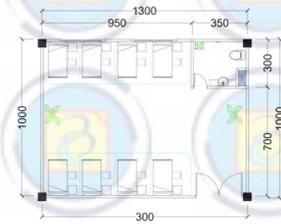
30. Denah Detail Arsitektur Kamar Rawat Inap Kelas I
